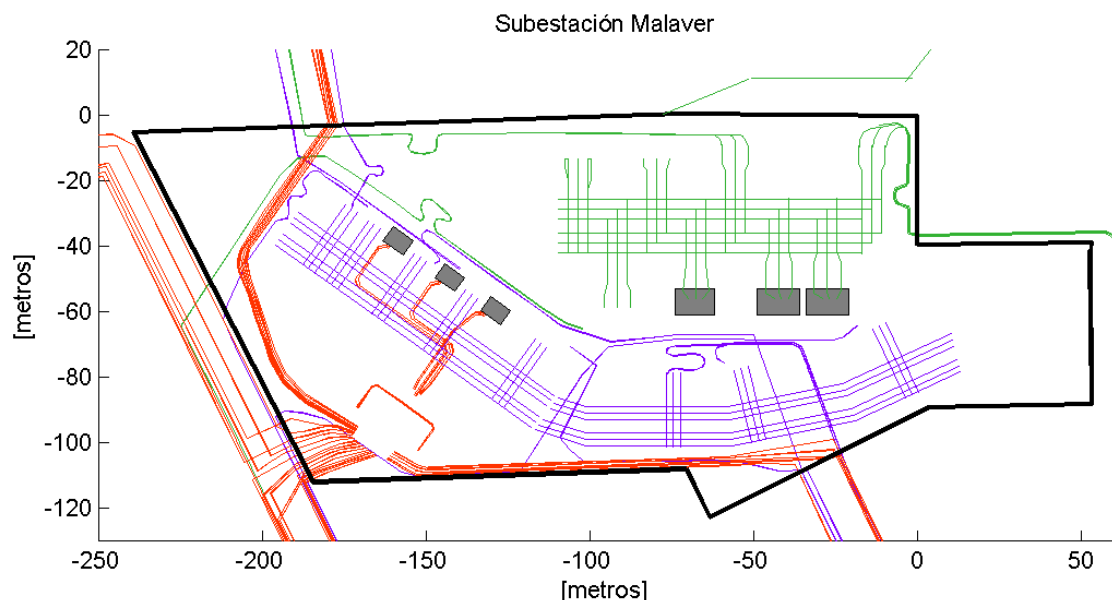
Vista en Planta de la Subestación Malaver. (Situación Futura)
